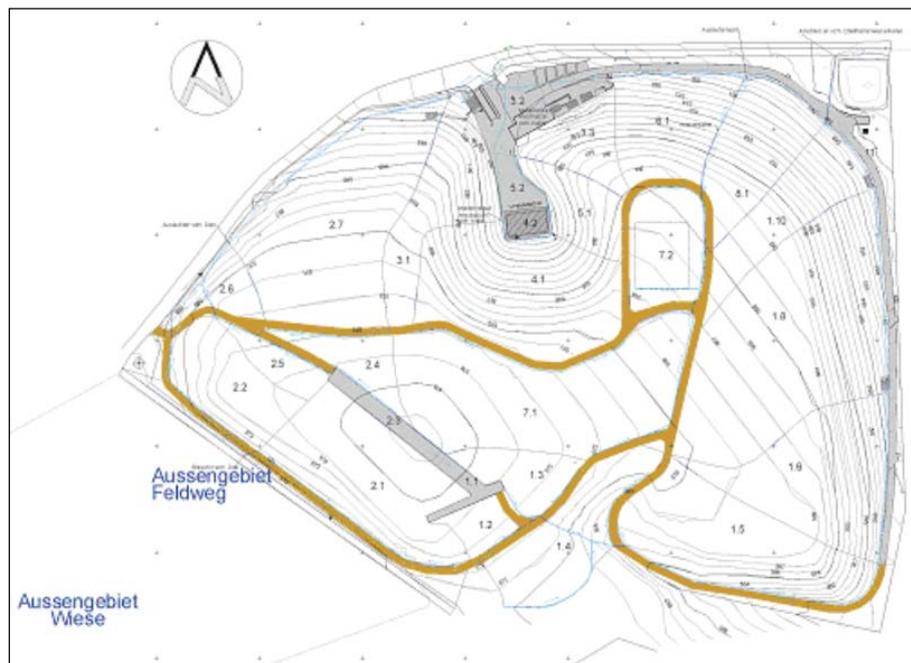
Lageplan der Deponie Horb-Rexingen (Endzustadt).
